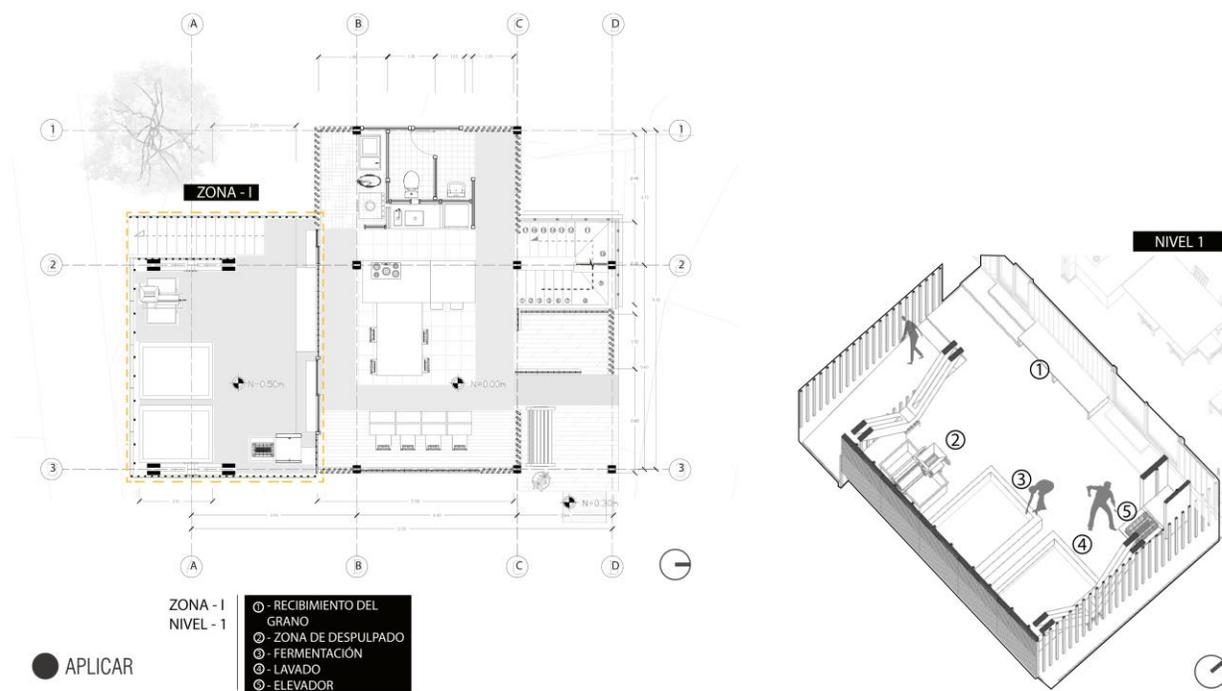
Planimetría: Zona I Nivel I. Elaboración propia.
